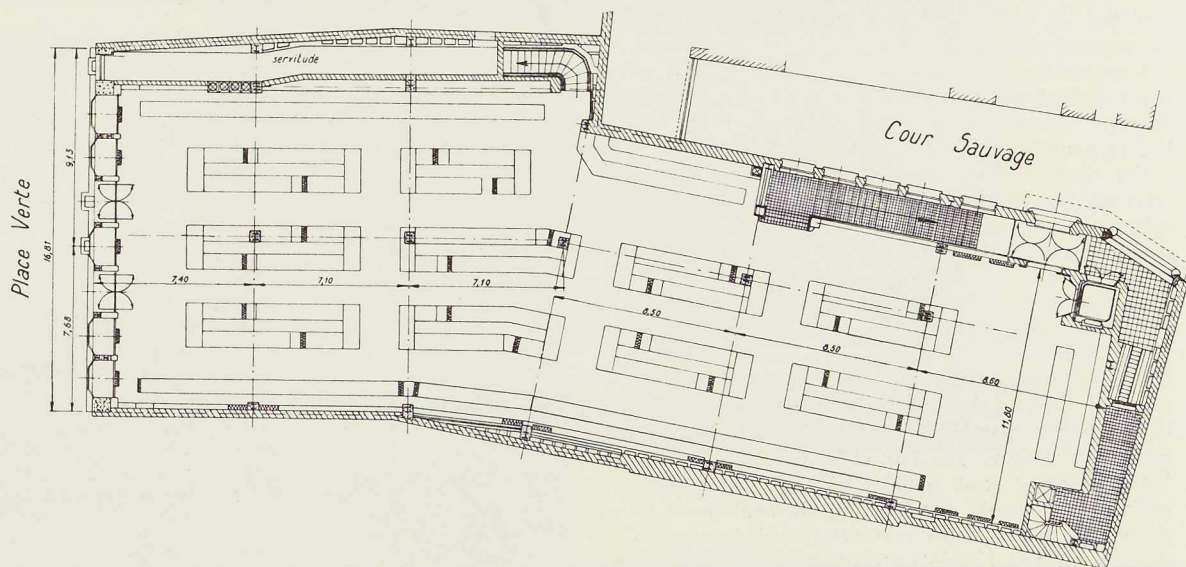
Vue en plan du rez-de-chaussée montrant la disposition des bergeries.
